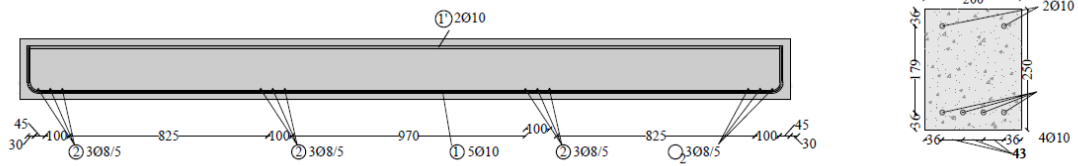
Disposición armadura longitudinal de Acero. Grupo 1. Ensayo armadura pasiva
